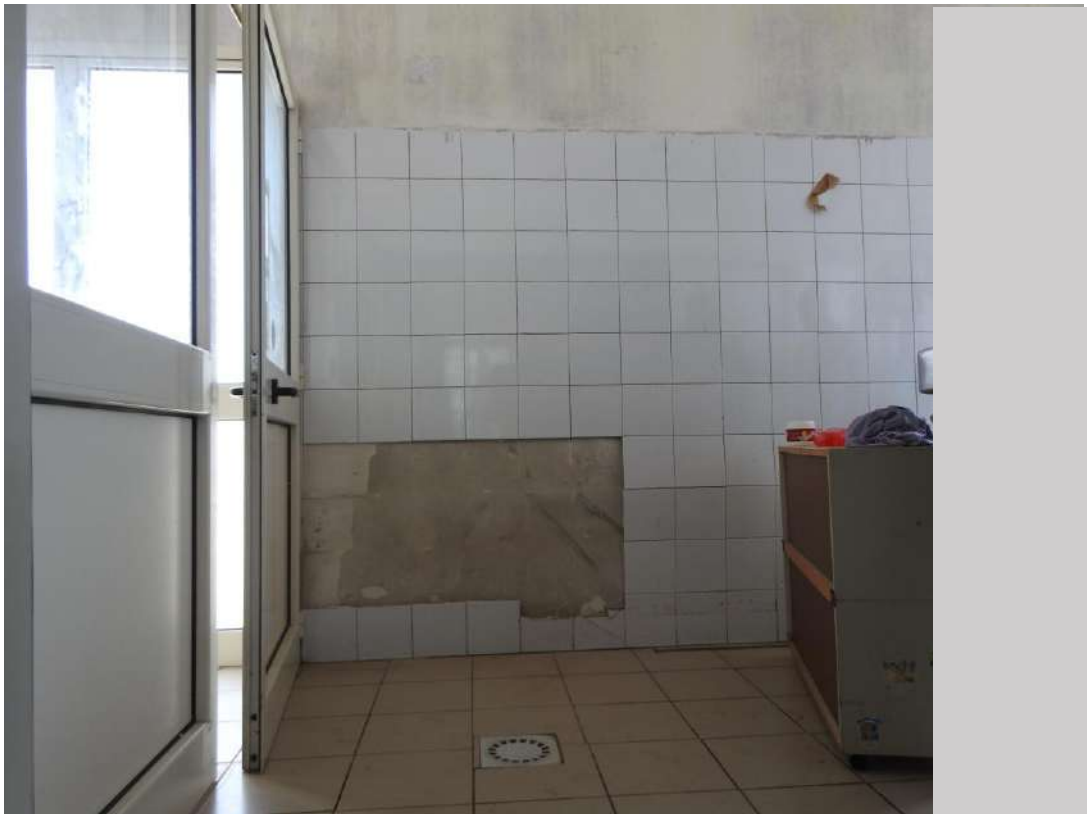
Fabbricato A, minicaseificio. Foto interna zona ingresso, particolare rivestimento deteriorato
